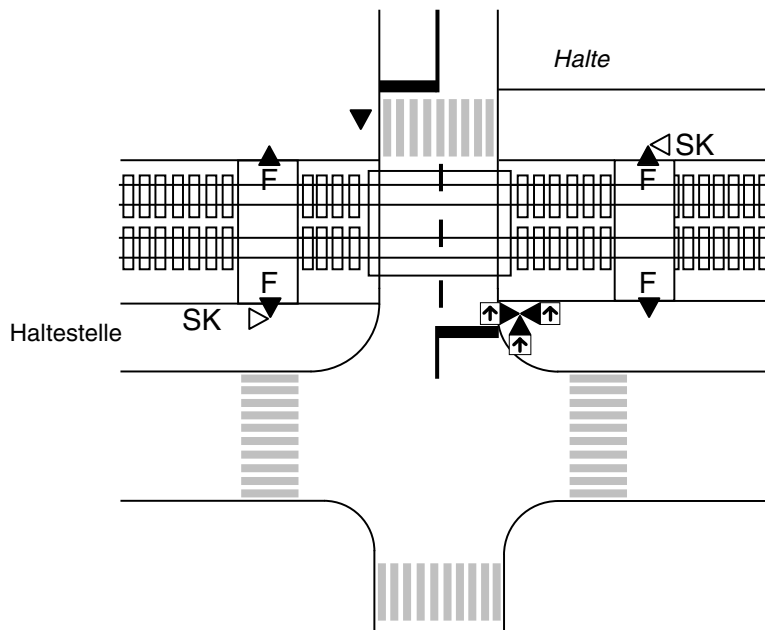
Croisement rail/route lorsque le point de croisement n'est pas facilement reconnaissable
